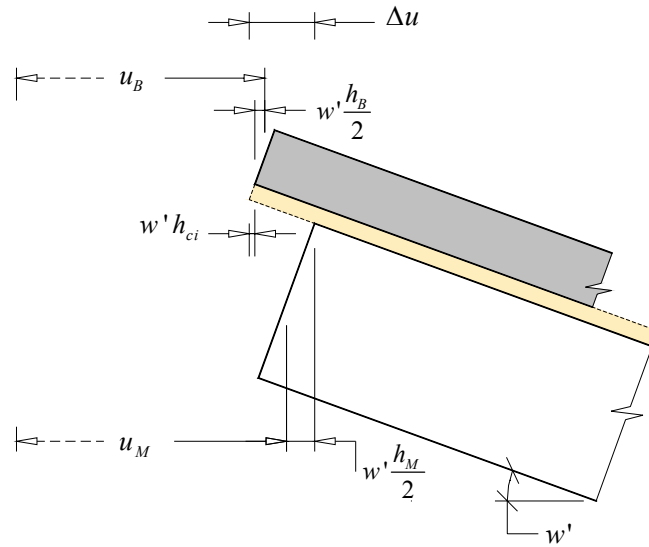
Troço da viga mista com escorregamento relativo entre os dois elementos.
